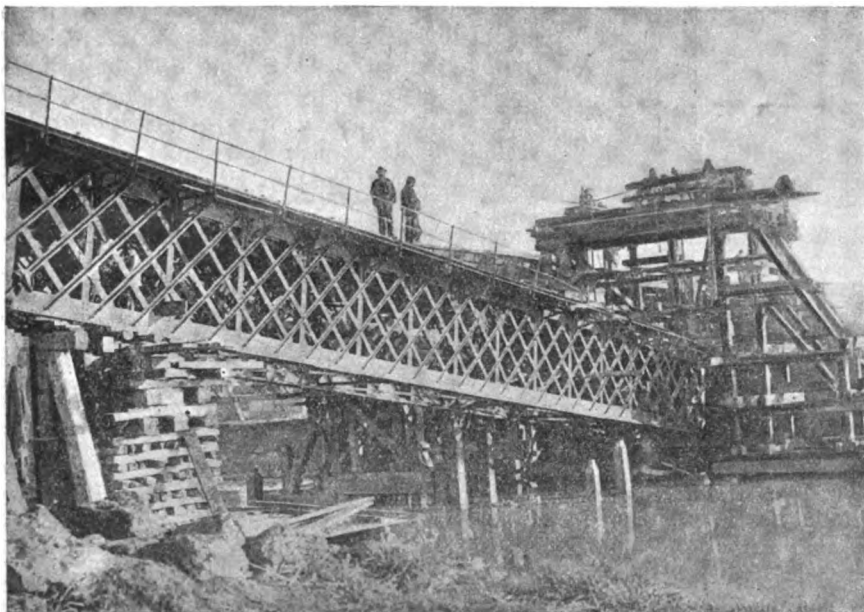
Rialzamento delle due travate del 1° ponte.
